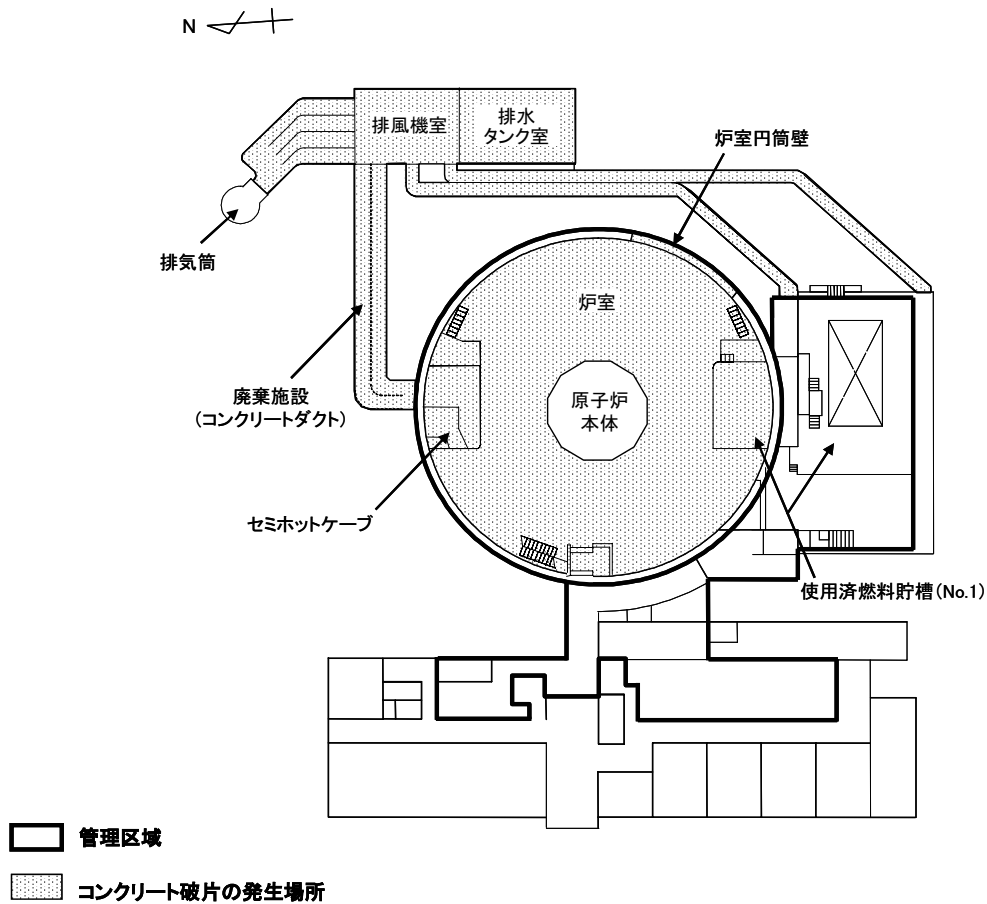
コンクリート破片の発生場所(JRR-3全体平面図)
